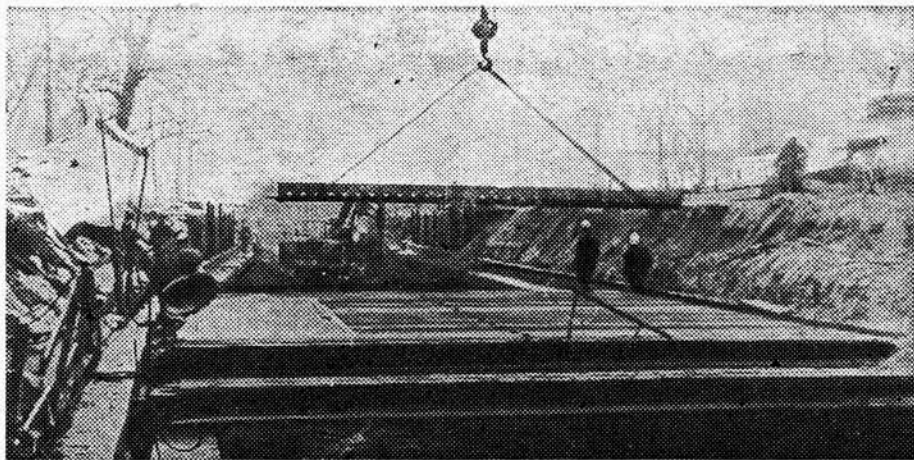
Монтаж балок перекрытия тоннеля будапештского метрополитена.
